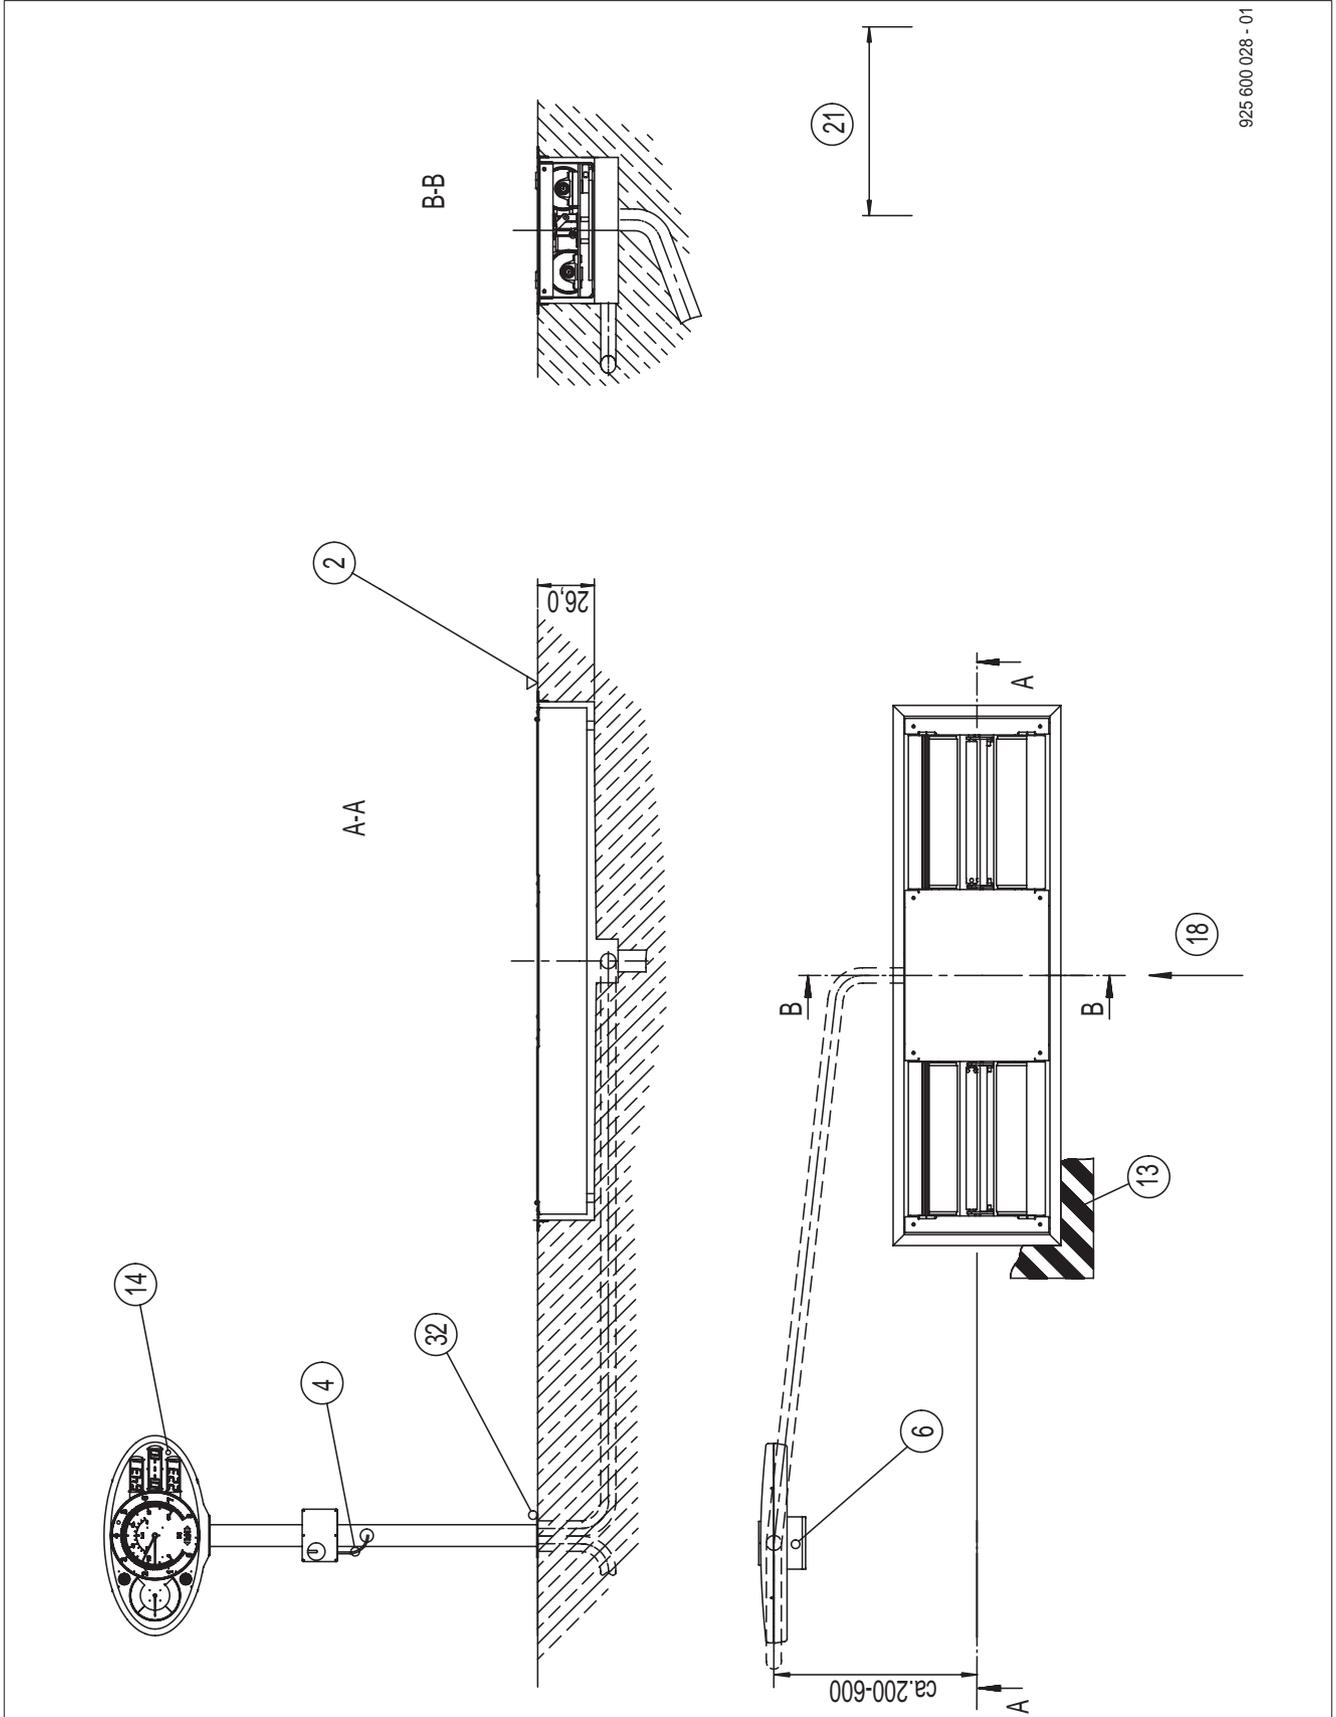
Installationsplan BD 6xx mit Standsäule - Übersicht
